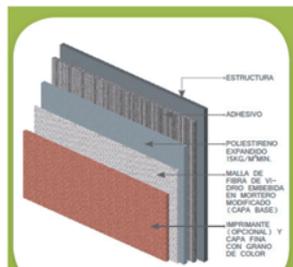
Componentes del sistema de barrera en estructura pesada (cabinetería u hormigón), vista isométrica.
